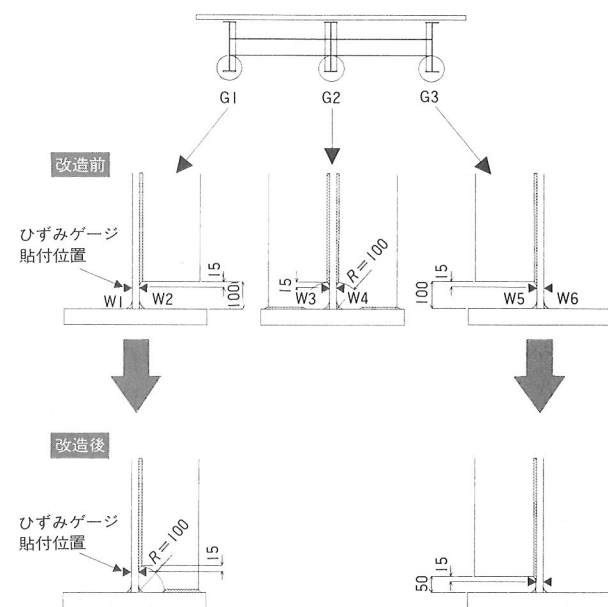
試験体の構造およびひずみゲージ貼付位置 (mm)
